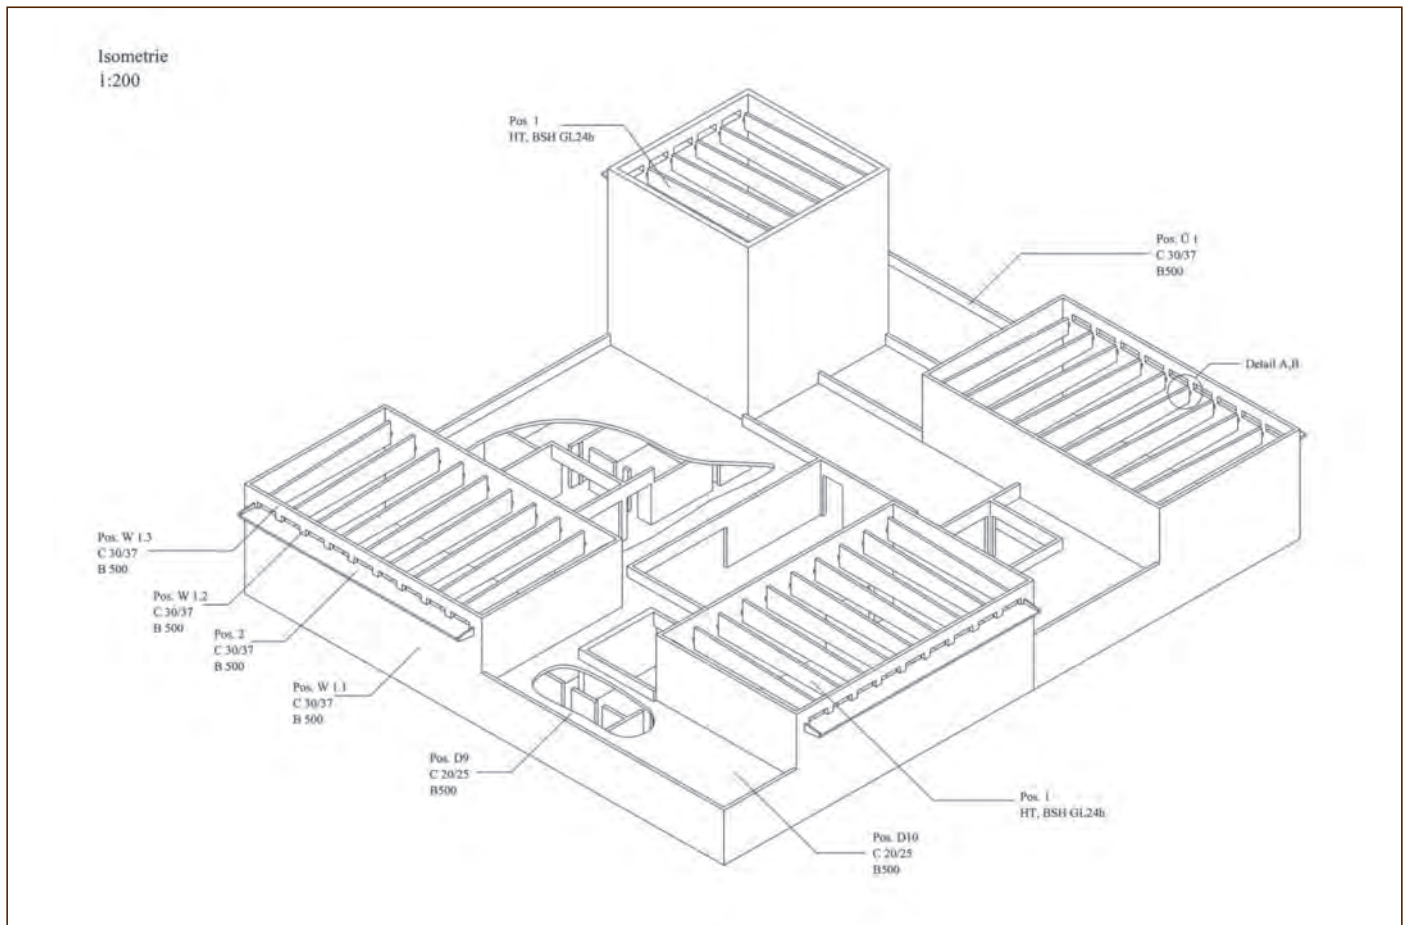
Isometrische Darstellung des Tragwerks, Projekt 2 – Sporthalle WS 2014/15, Verfasser: Arne Wittenborn (Bachelor Architektur) und Michael Adelung (Bachelor Bauingenieurwesen), betreut an den Lehrstühlen Baukonstruktion und Stahlbau
